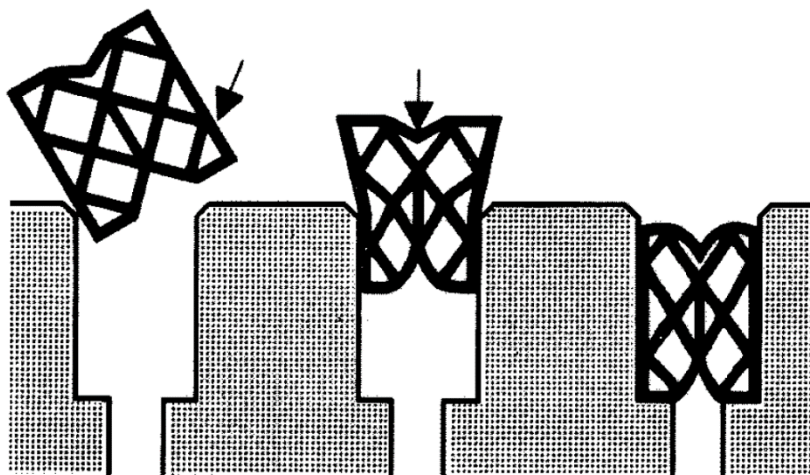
Esquema de instalação de um perfil de compressão alveolar (fonte: (Lima, J.M., 2006))
